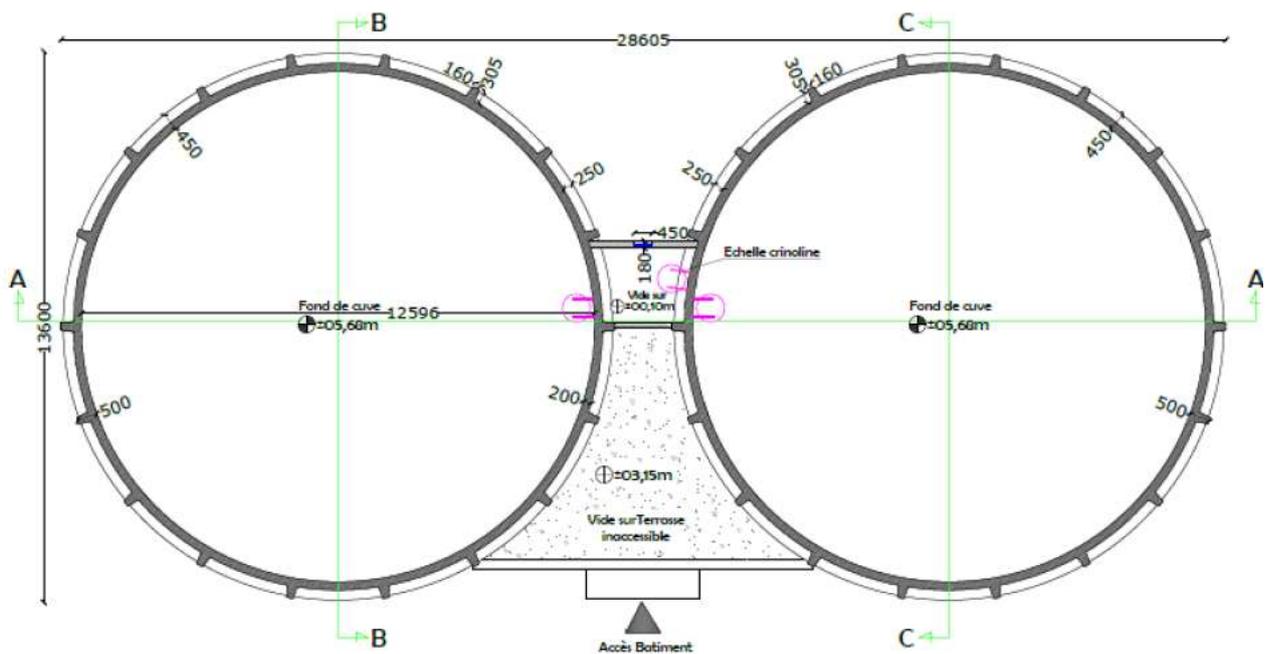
Plan des réservoirs R1 et R2 (Rapport STRUCTUREO)
